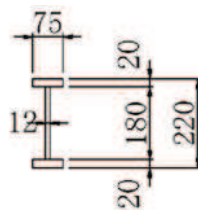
補助縦桁の断面形状 (単位 : mm)
